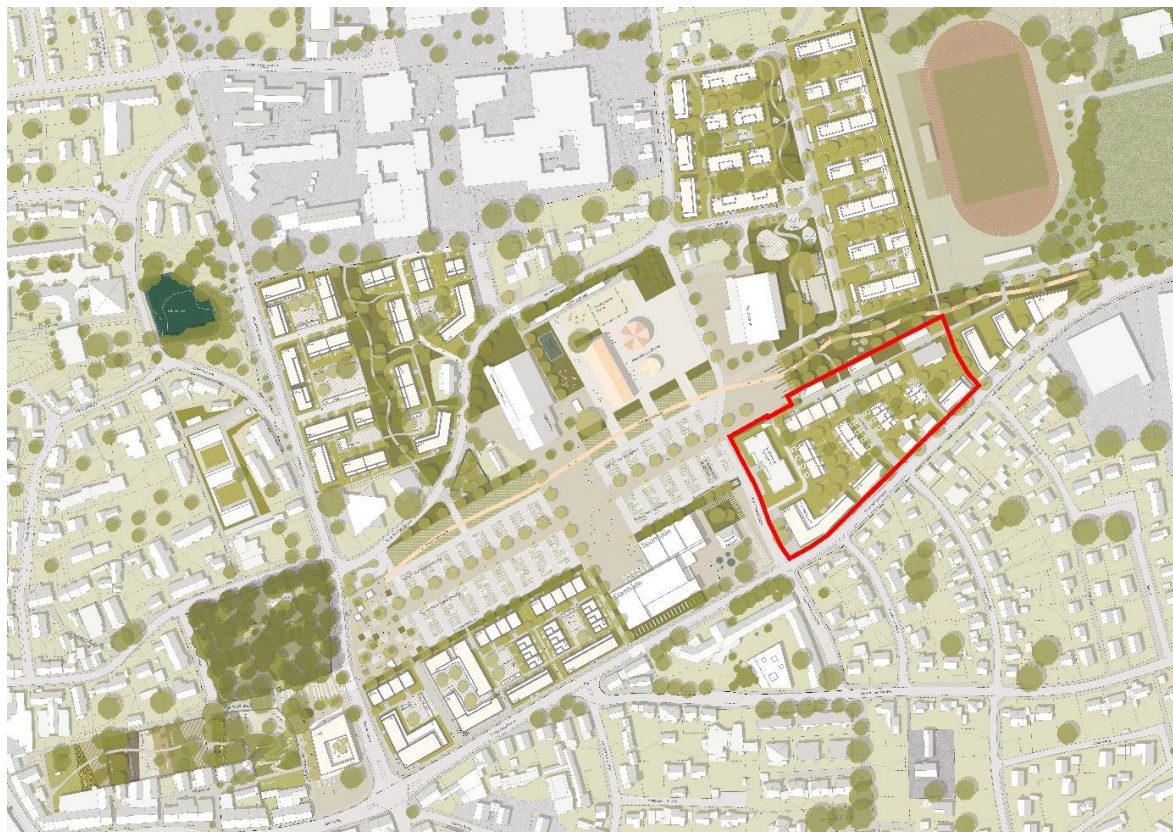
Masterplan "Östliche Innenstadt" mit markiertem Plangebiet „Am Schönebürgstadion II“
